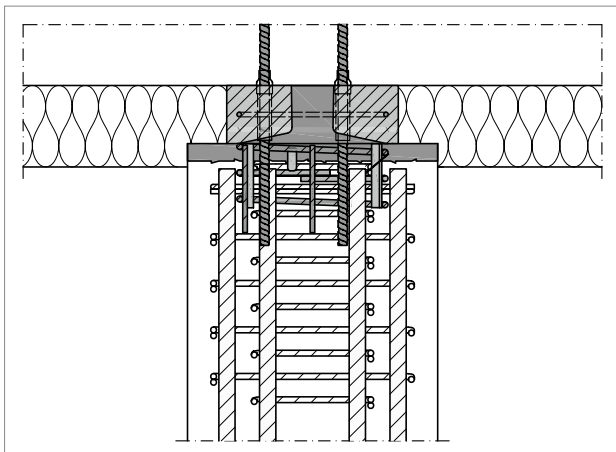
Schöck Sconnex® type P: Wapening in zone 2 - lengteprofiel van de kolom
